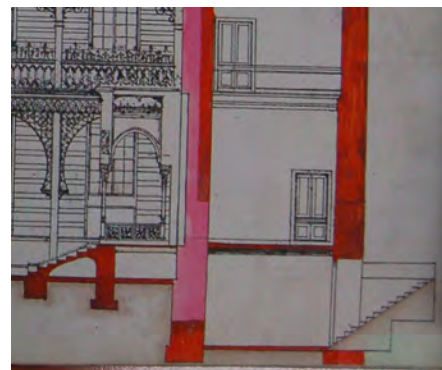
Planmaterial Ausschnitt Längsschnitt
